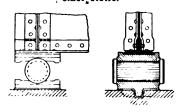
u. 415. Rollenlager mit nur einer Rolle.
